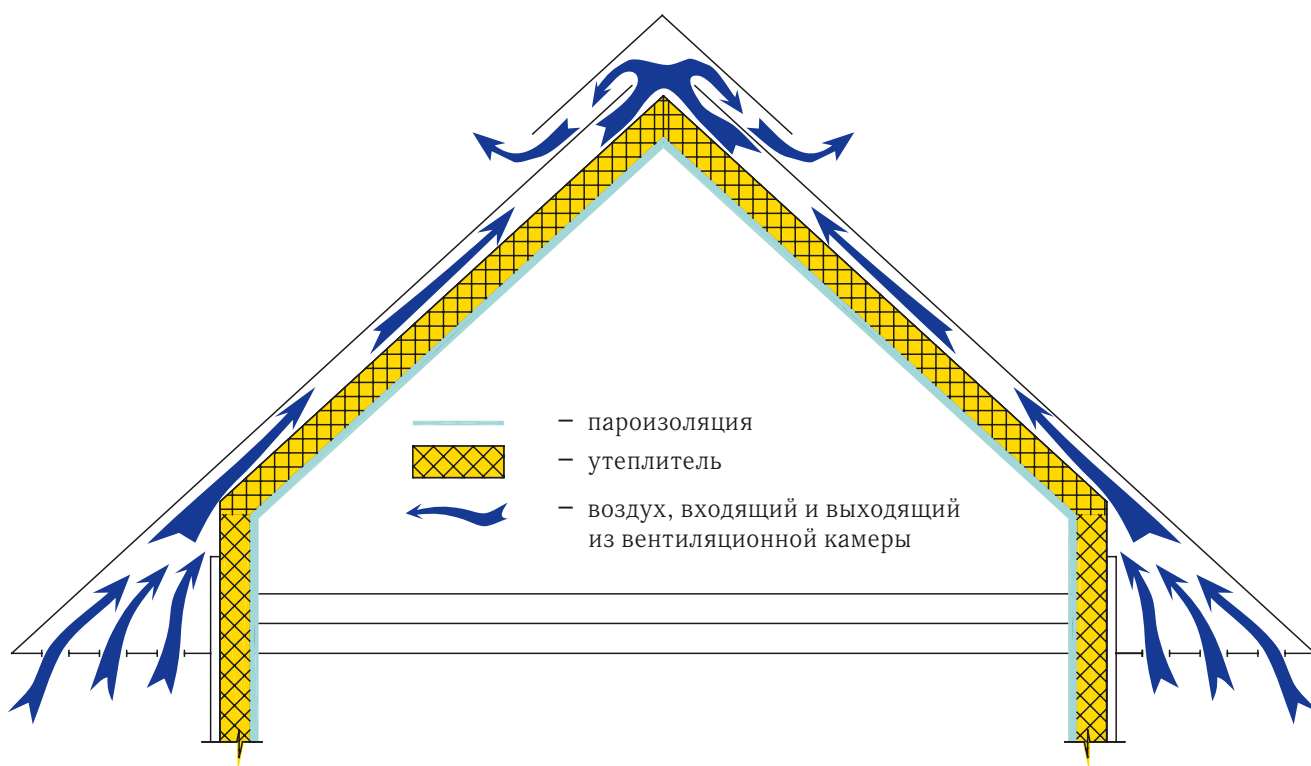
Схема утепления, пароизоляции и вентиляции жилой мансарды
